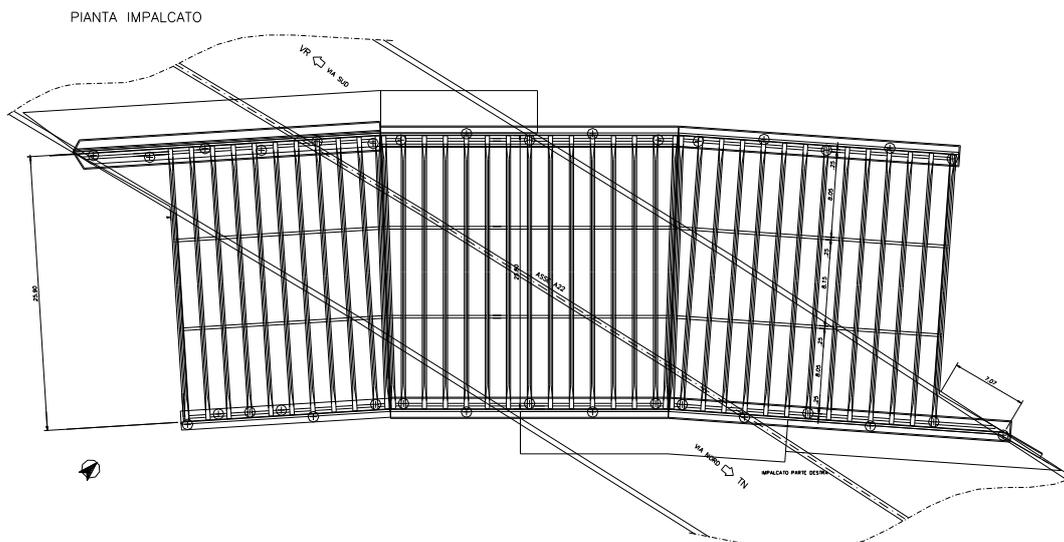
Pianta dell'impalcato nella situazione attuale del viadotto Zuane (km 202+085)
